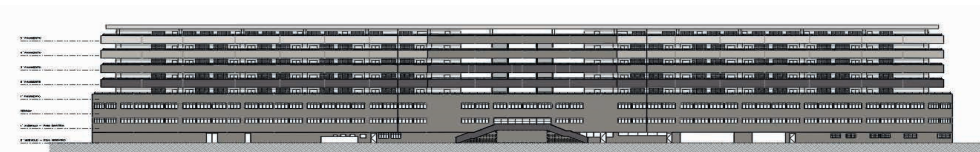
Fachada Norte voltada para a rua Ministro de Godói. Fonte: Arquivo FUNDASP.
